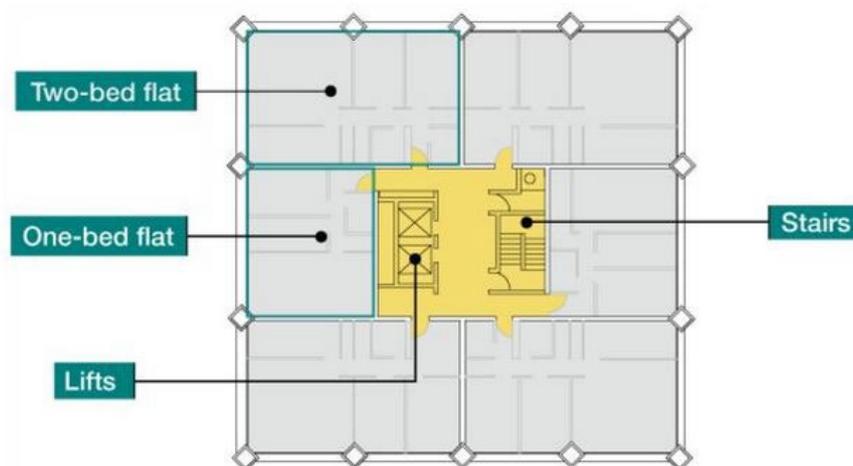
Plan d'étage typique de la tour Grenfell [3].
